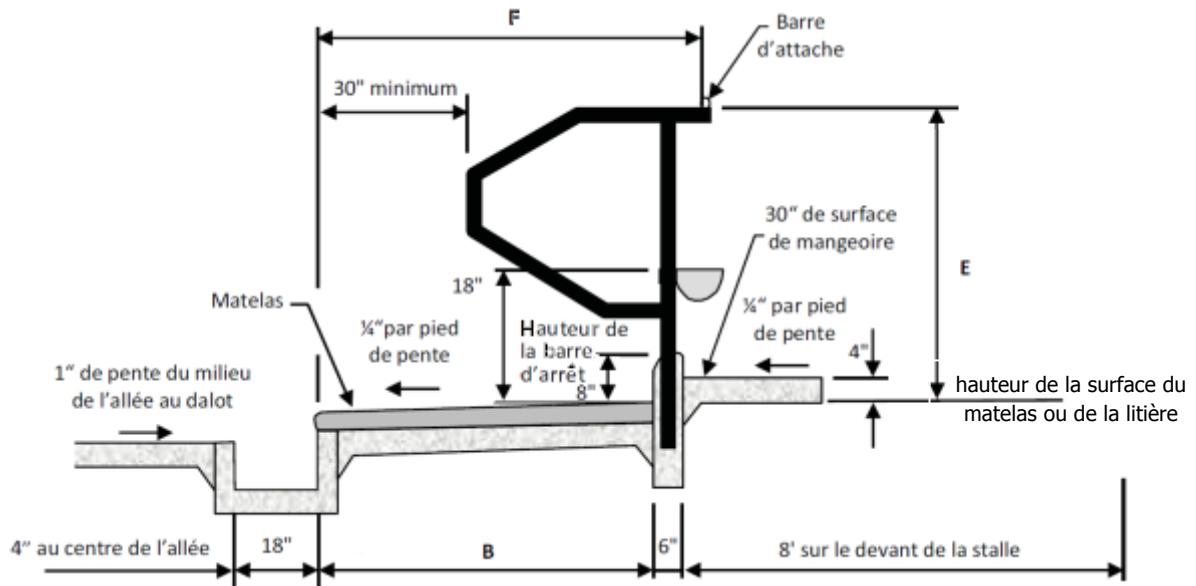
Configuration d'une stalle entravée (de type barre d'attache), les lettres symbolisent les dimensions équivalentes aux dimensions d'une stalle libre (Figure 1), B : distance du dalot à la bordure d'arrêt, E: hauteur de la barre d'attache, F : distance horizontale entre la barre d'attache et le dalot (d'après MAAARO, 2008).
